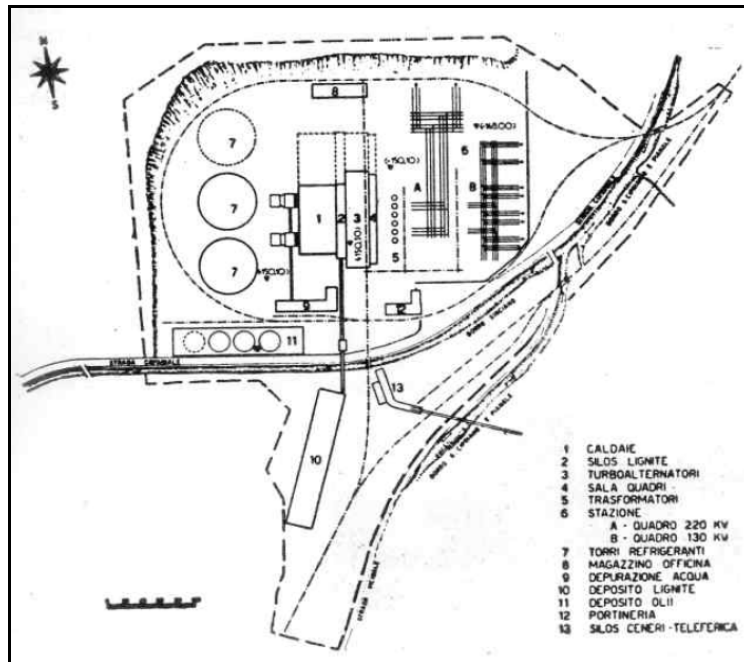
PLANIMETRIA NUOVA CENTRALE
